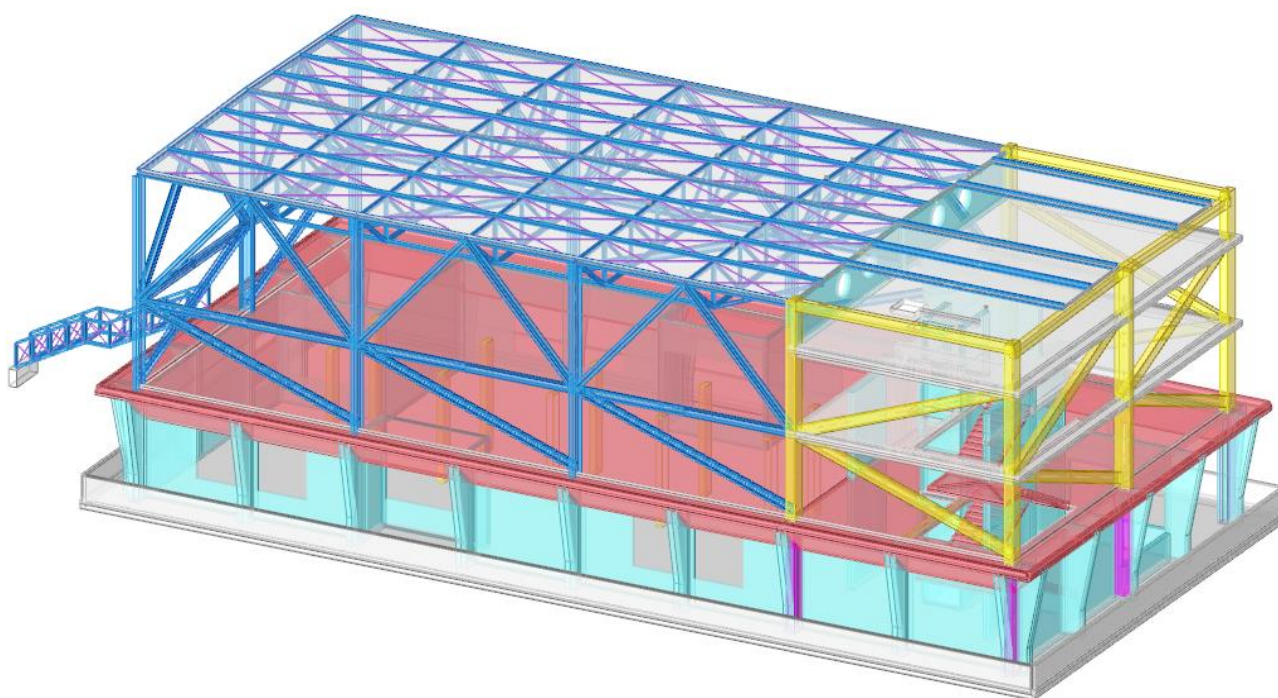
Vista 3D del Modello Strutturale FEM – Corpo A – Vista Assonometrica – Stato di Progetto
